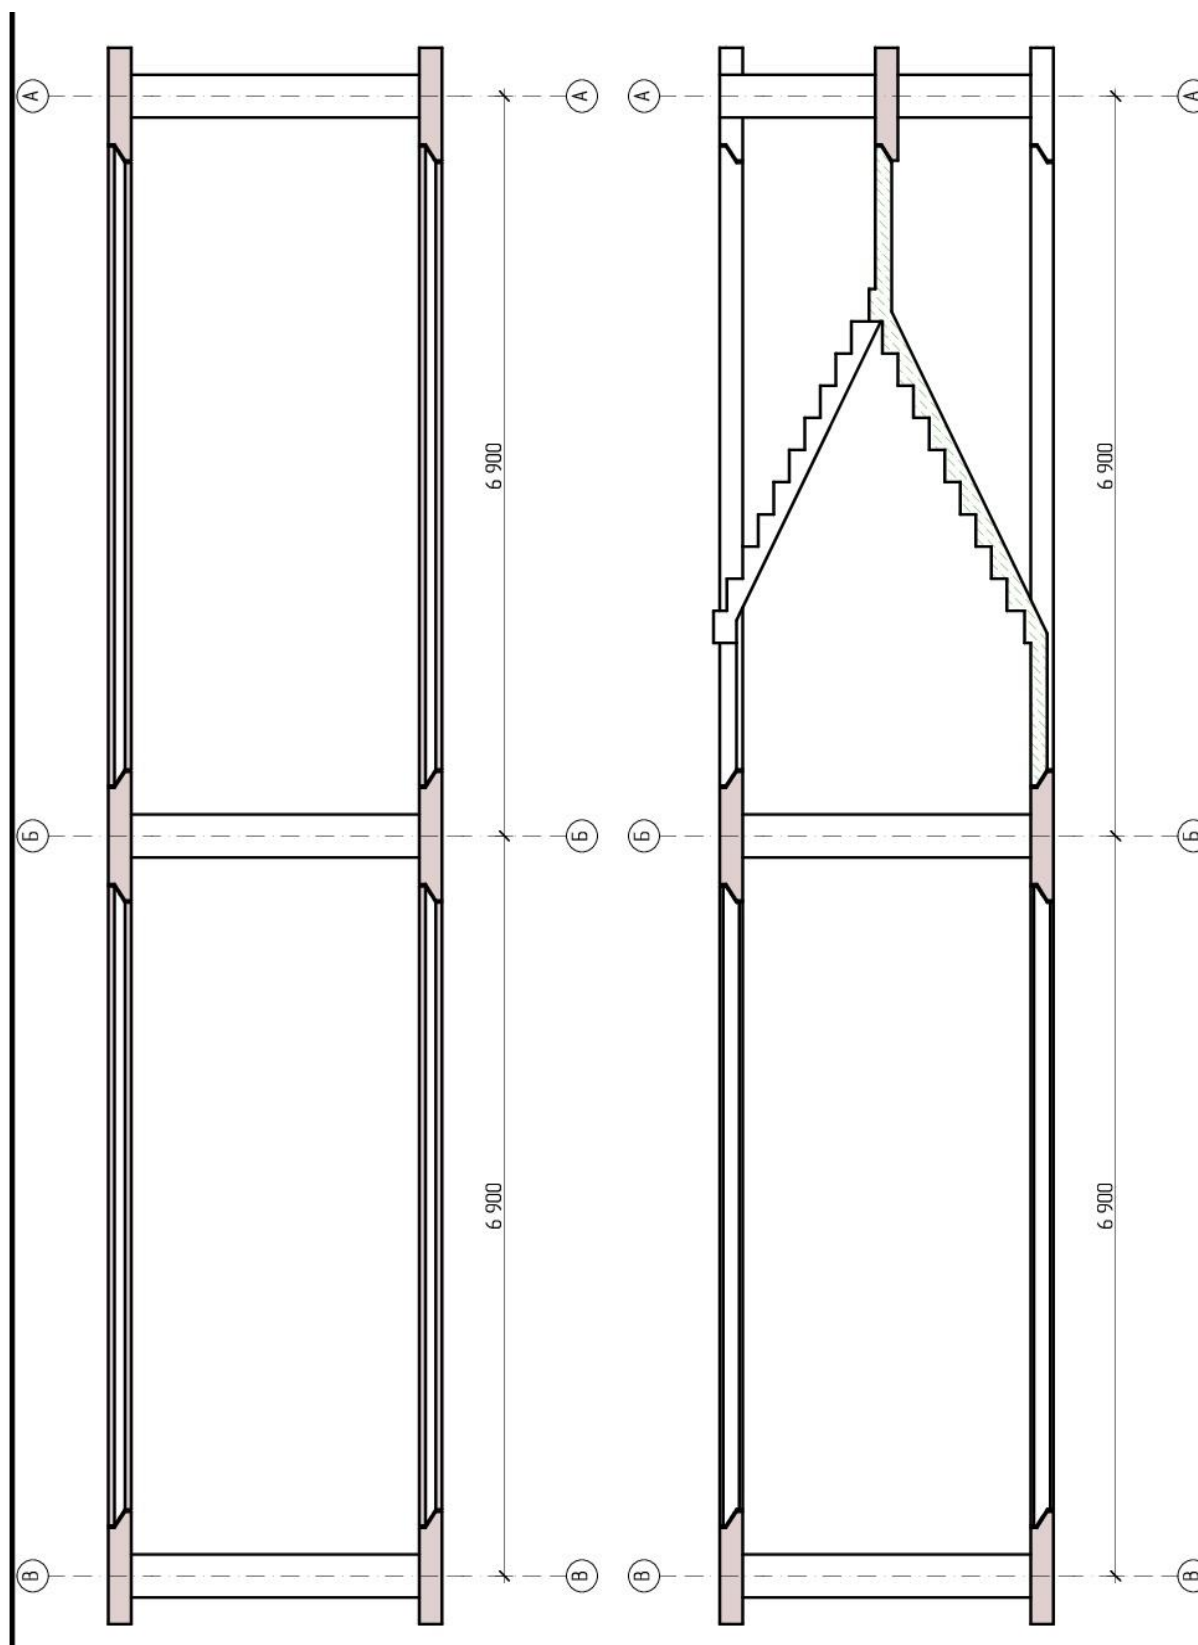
ЧСхеми поперечного перерізу типового поверху розробленої системи поверху
